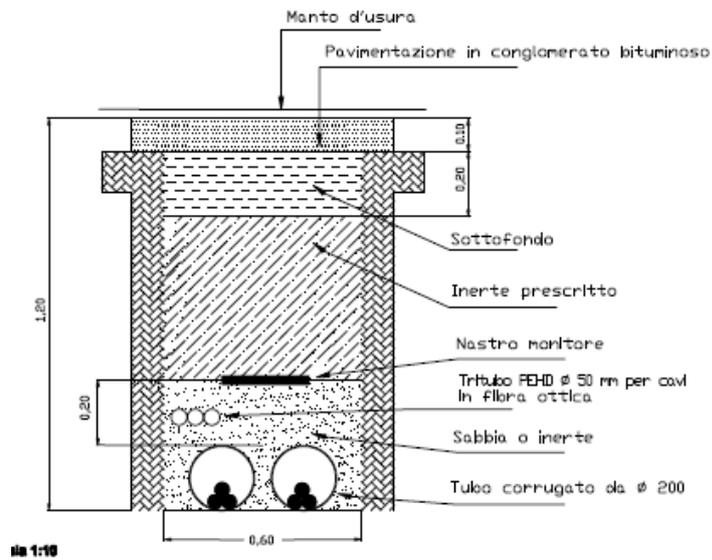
Sezione su strada asfaltata - posa di n°2 cavi MT
